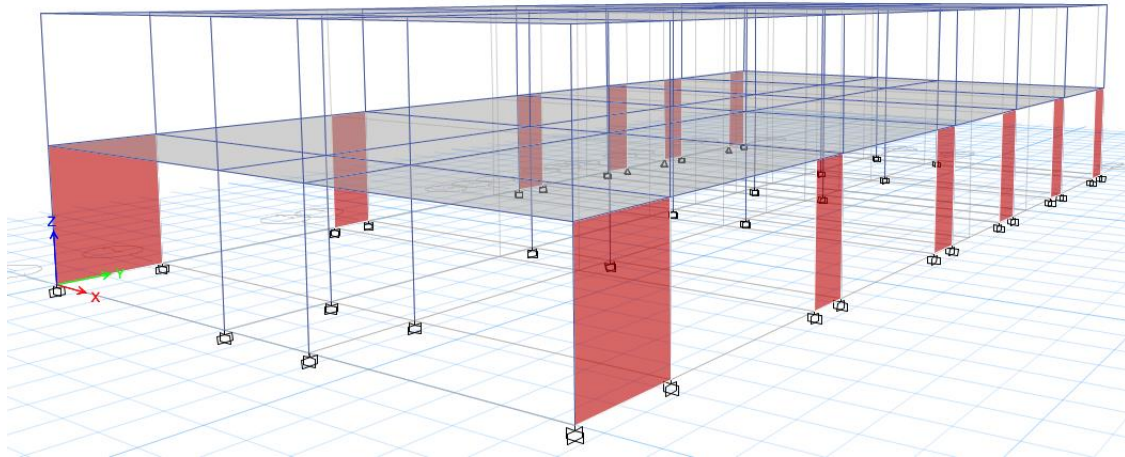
Vista en 3D de la estructura 1 del pabellón de emergencia.
